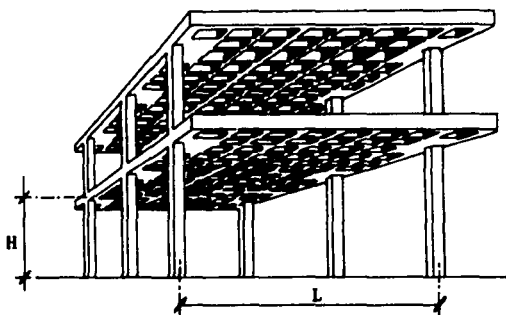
Estructura de concreto reforzado a base de columnas y losa plana.
